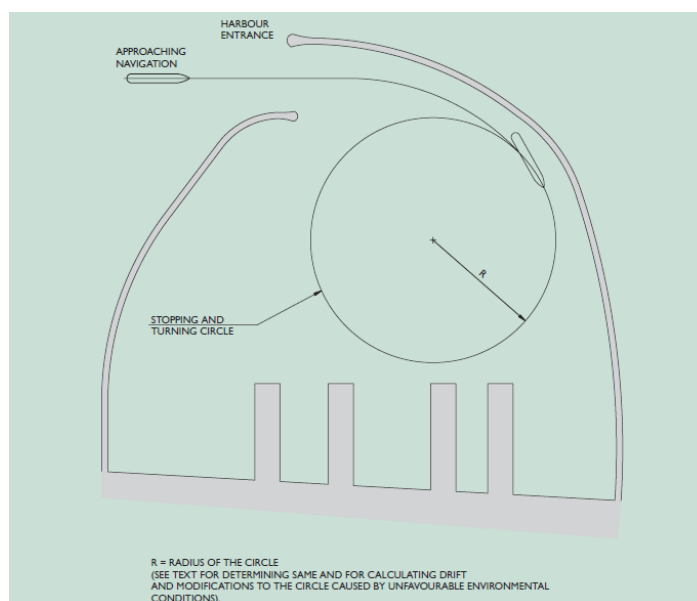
Planta da área de manobras dentro de um porto – Fonte: ROM 3.1-99, 2007
